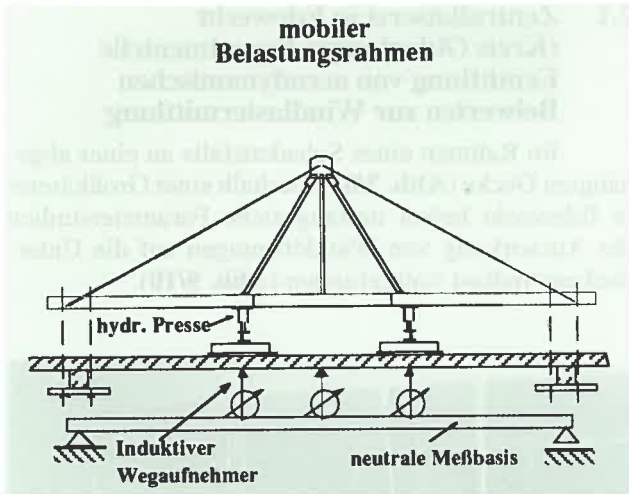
Testlasterzeugung durch internen Kräftekreislauf
